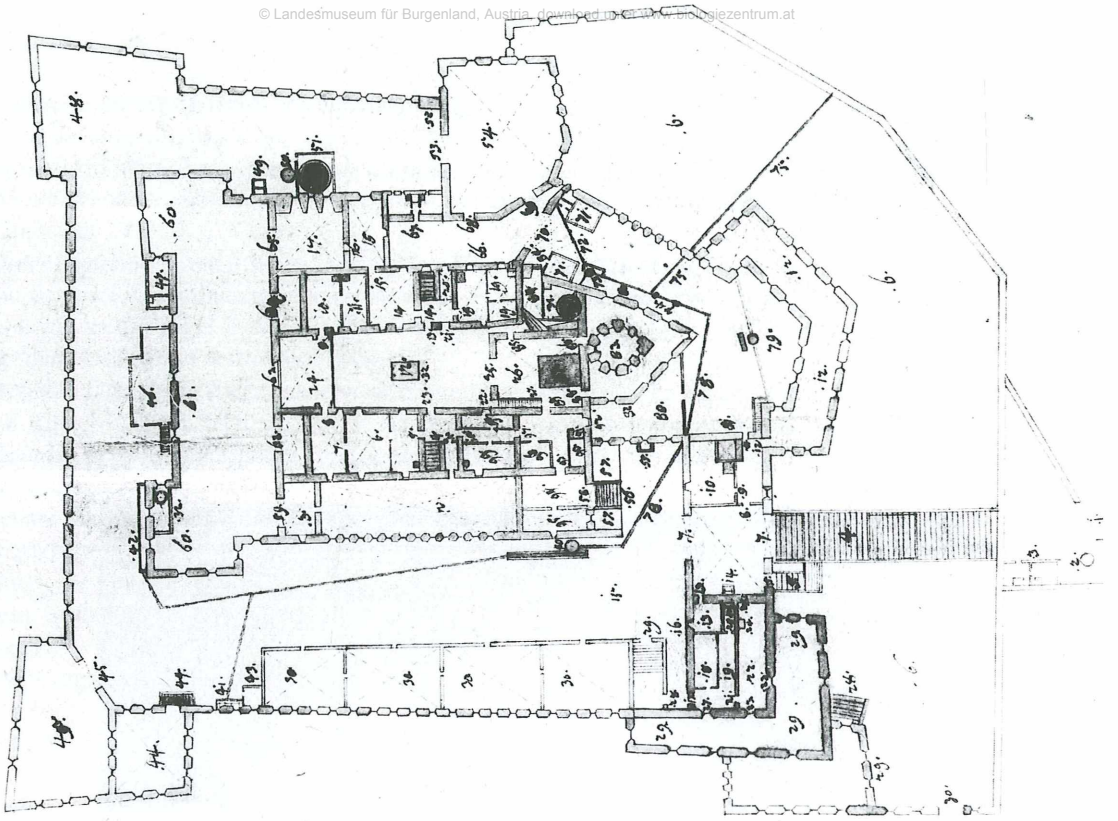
Grundriss der Burg von Franz Karl Brabant, um 1691
